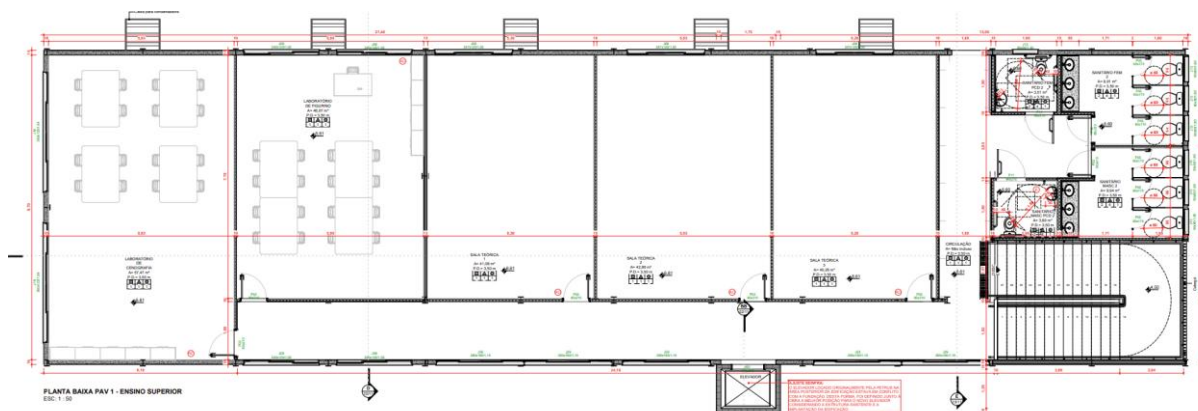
Planta Baixa Pavimento 1 – PROJETO ORIGINAL
